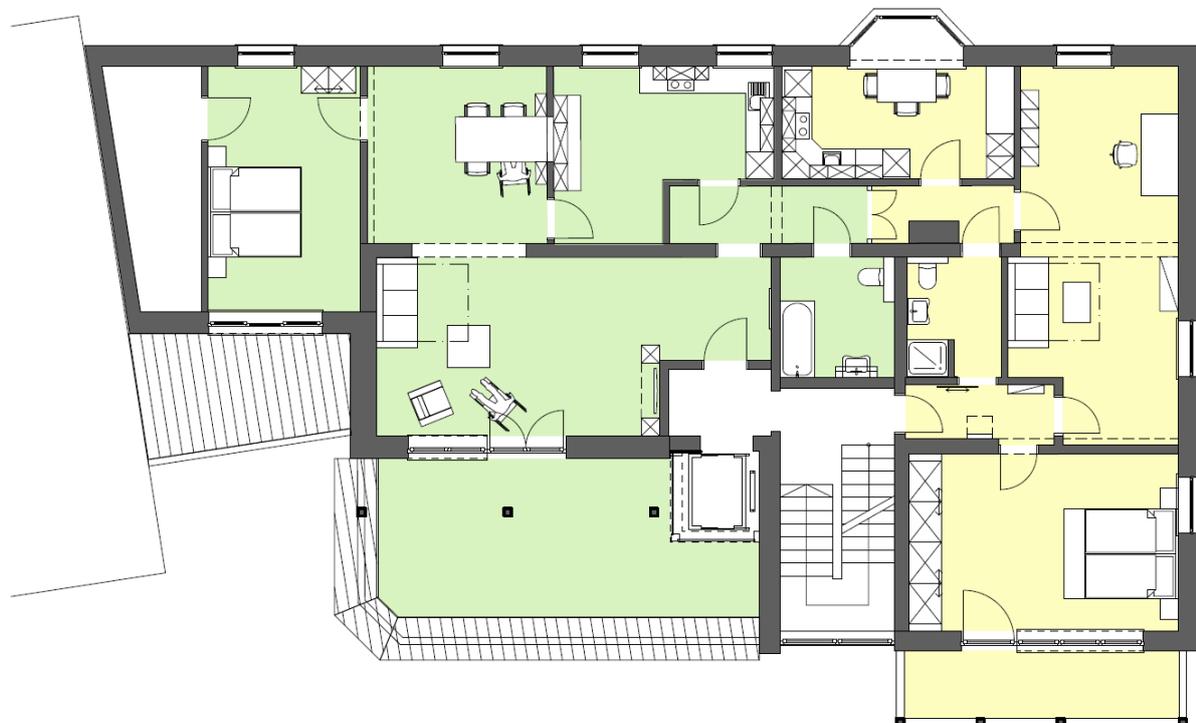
Grundrissplan mit Erstausrüstung Möblierung
